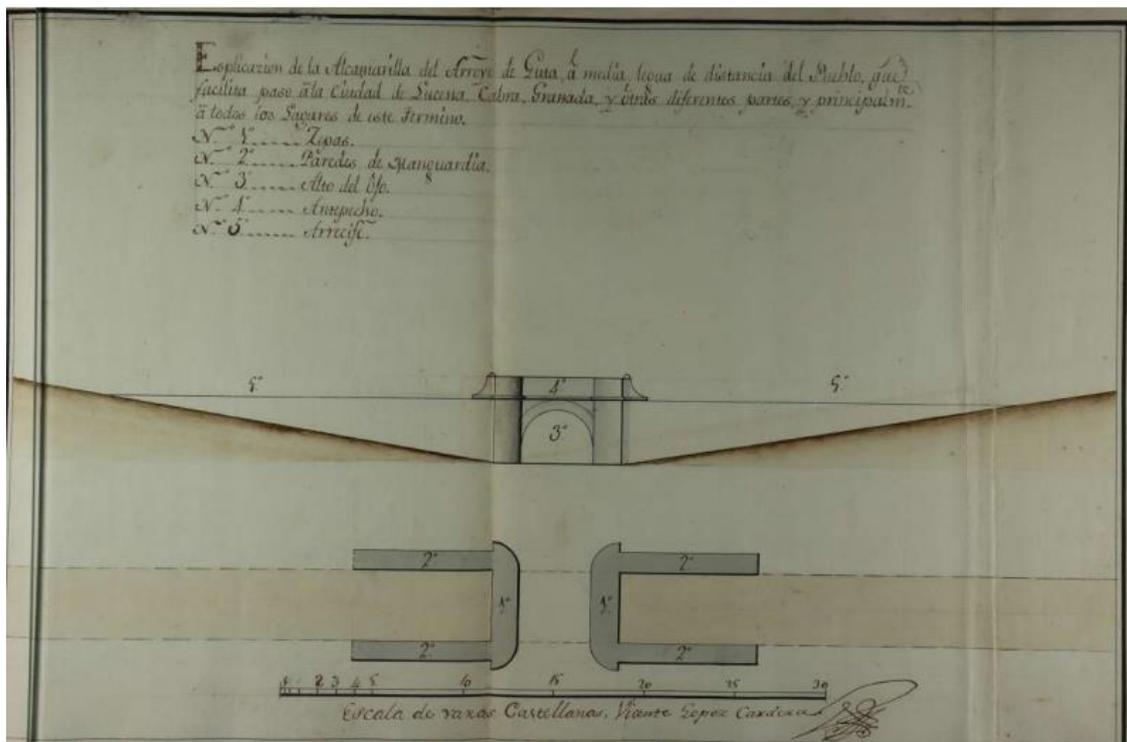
Alcantarilla del arroyo de Guta. Autor Vicente López Cardera, 1794.
